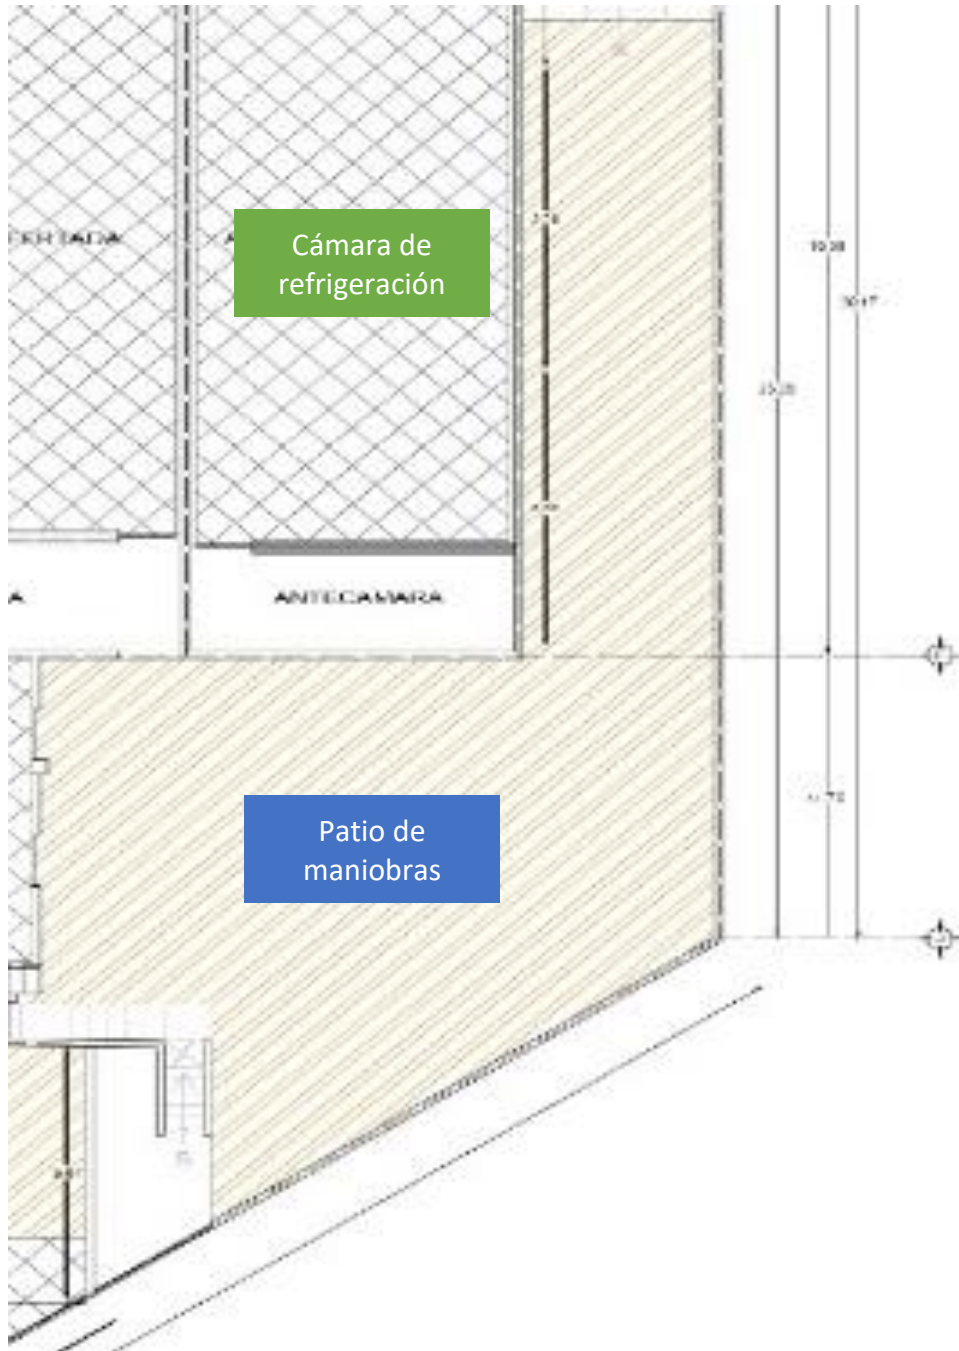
Plano arquitectónico de las instalaciones terrestres de PSG (planta baja).
